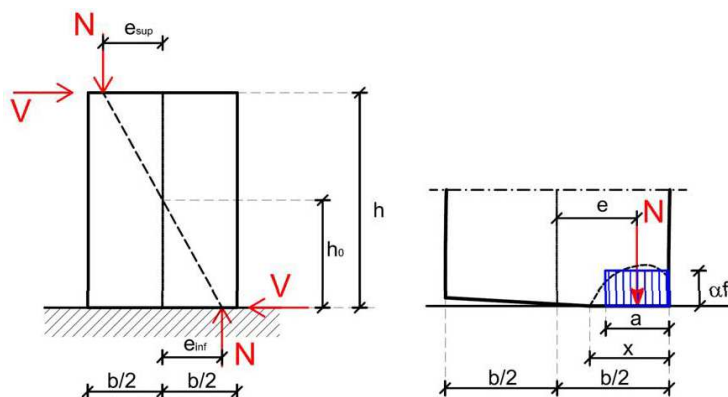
raffigurazione della situazione in cui si trova un elemento soggetto a pressoflessione
